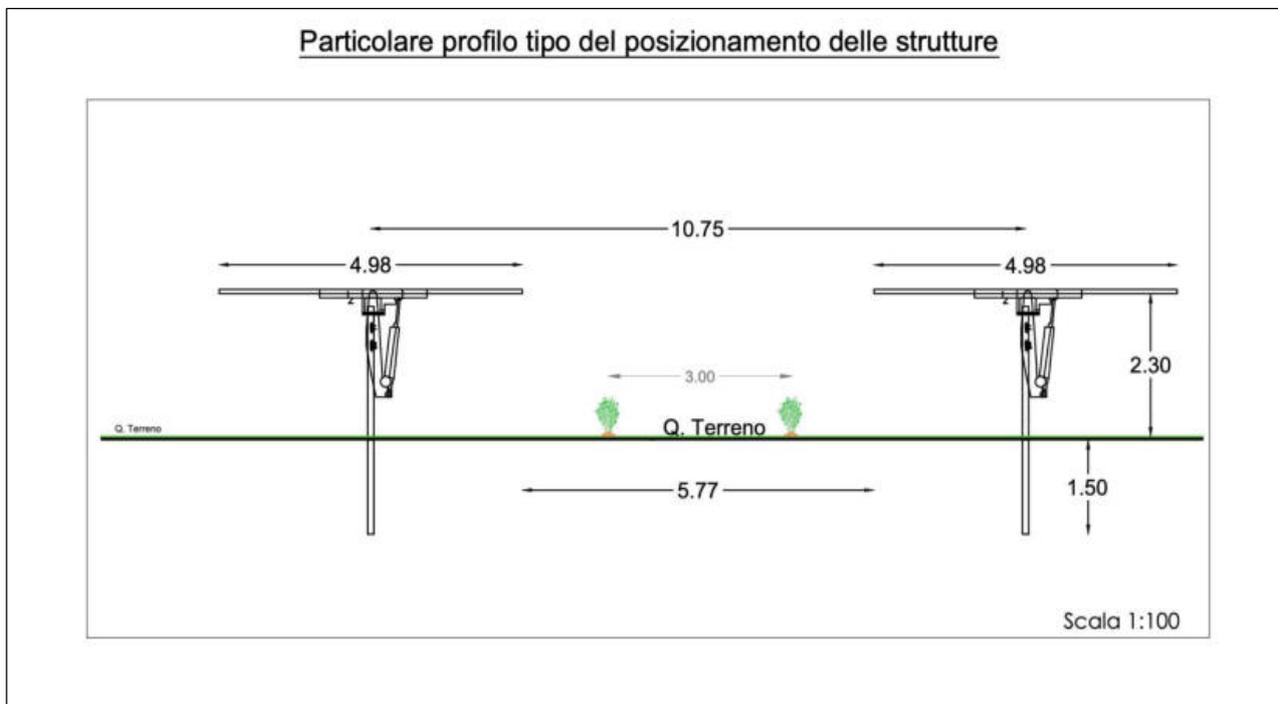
Particolare posizionamento strutture e coltivazione interfilare Campi 1,2,3.
